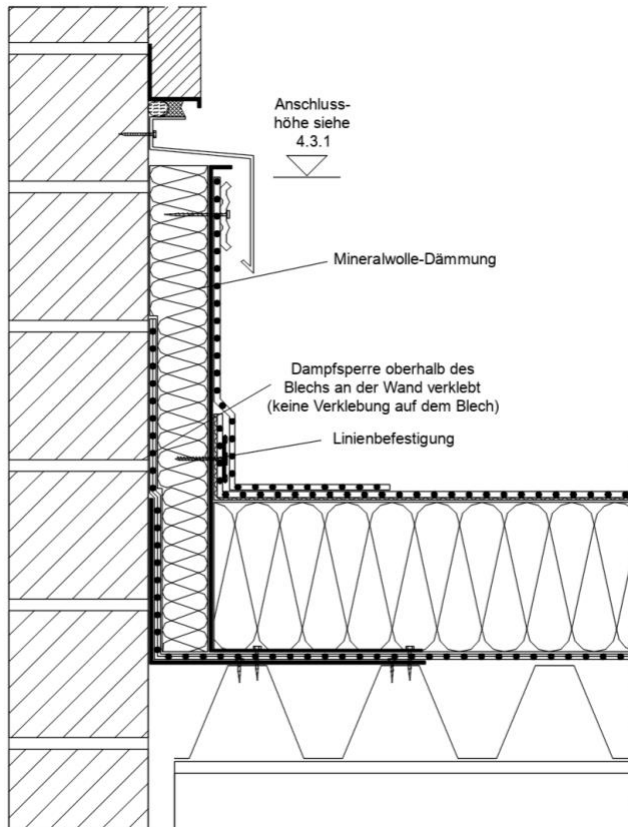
Beweglicher Wandanschluss mit Betonaufkantung – Ausführung mit Bitumenbahnen
